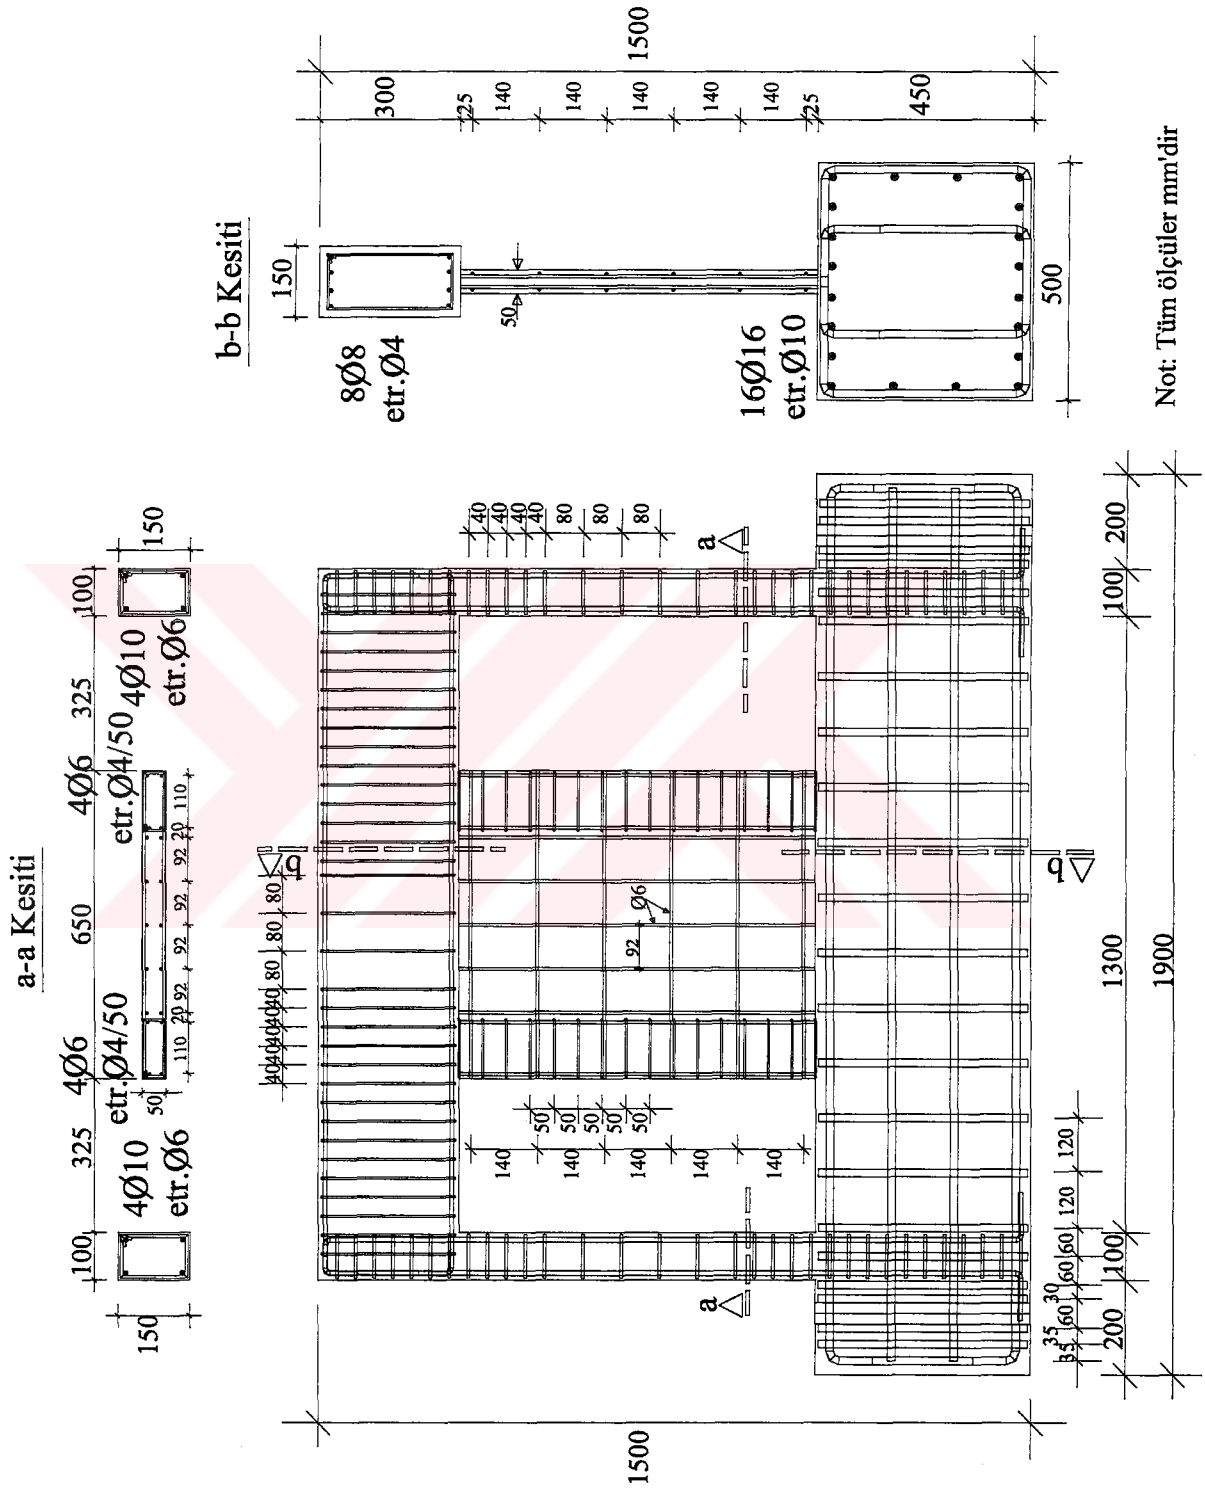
Deney Elemanı-5'in donatı detayı
